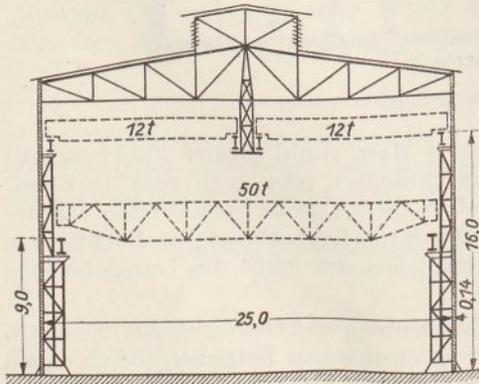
Einschiffige Halle, obere Kranbahnen an Mitte Dachbinder gehängt.
